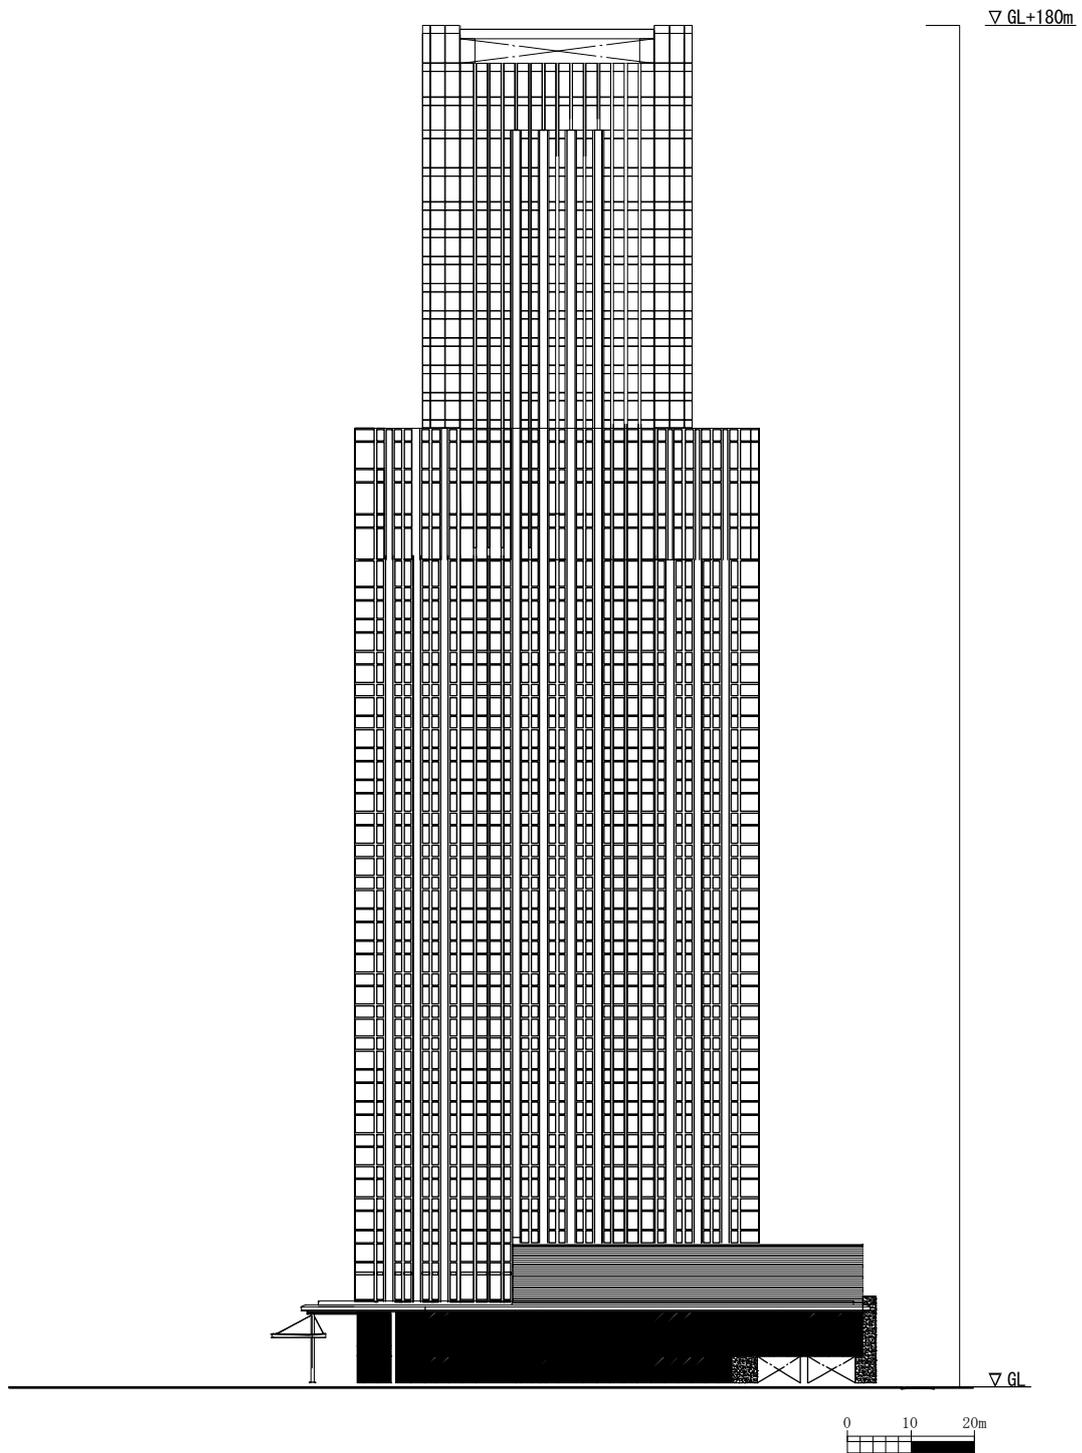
(8) 計画建築物立面図 (北側) (評価書(計画))
